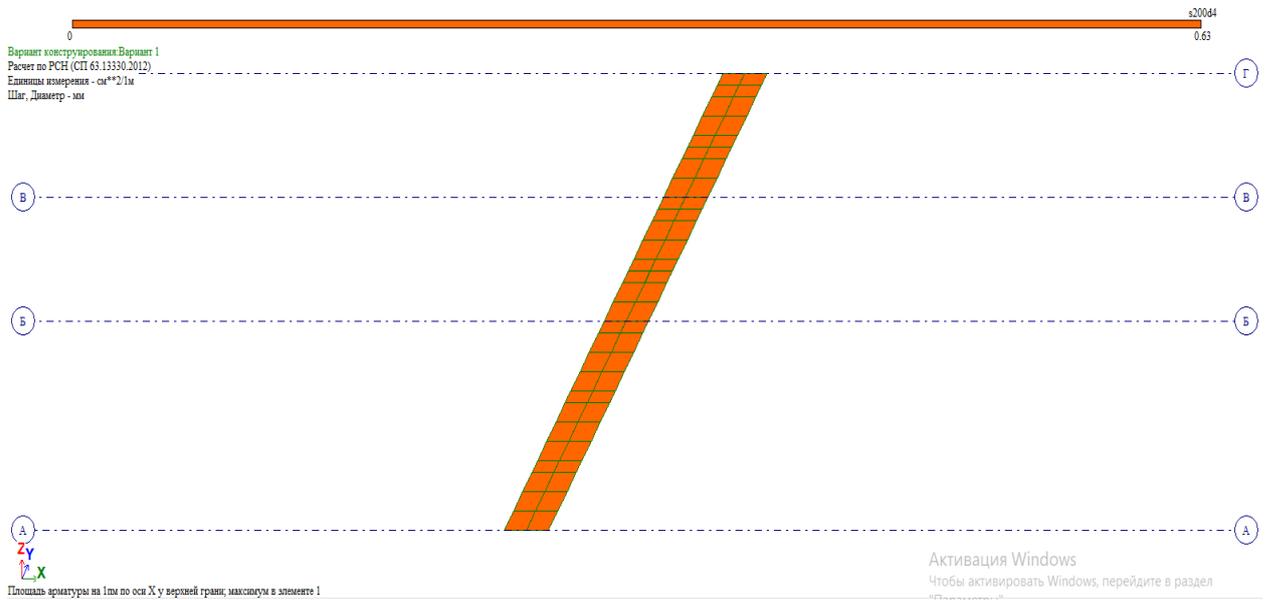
Подбор нижней и верхней продольной арматуры плиты по оси
